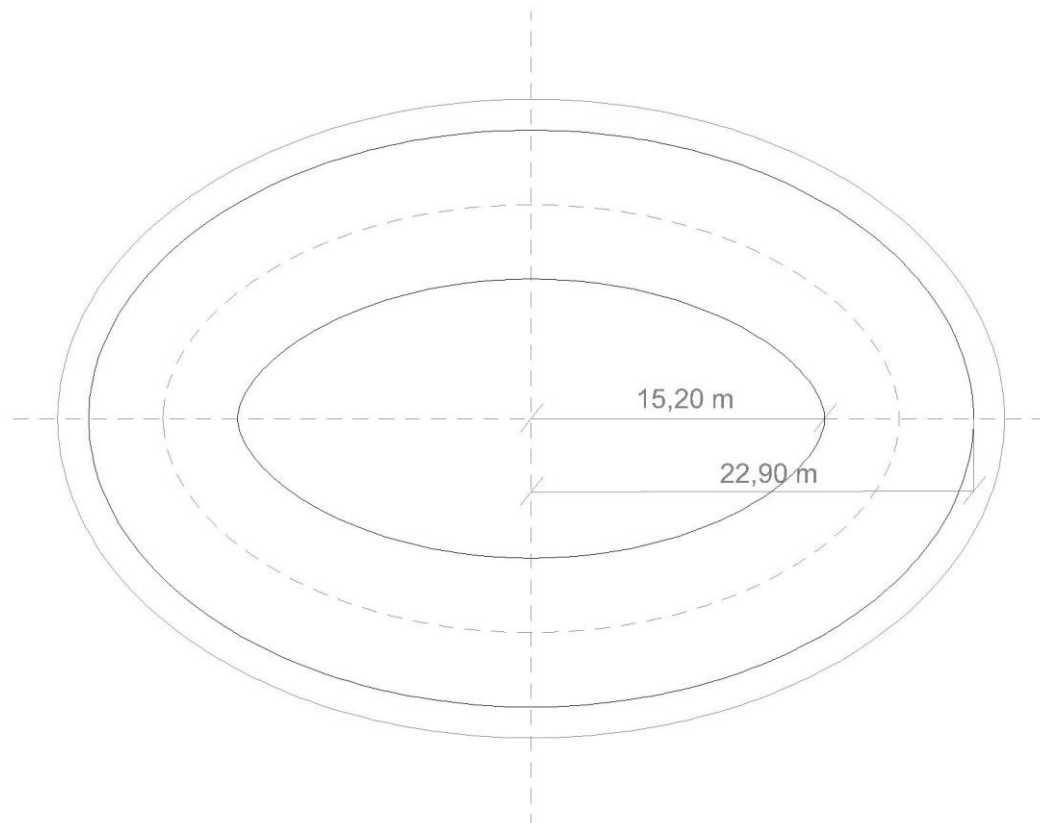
Esquema planta Torre Sevilla, imagen propia
